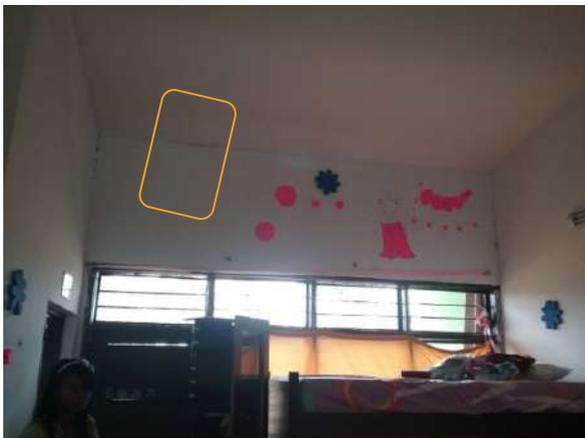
Grietas sobre muros mampostería Bloque 10
